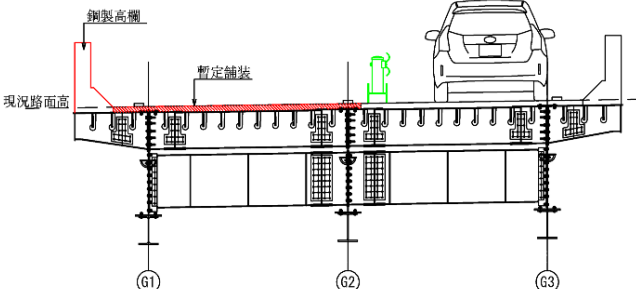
1車線規制における Elevator-deck 工法を用いた既設 RC 床版から鋼床版への取替え概要図
